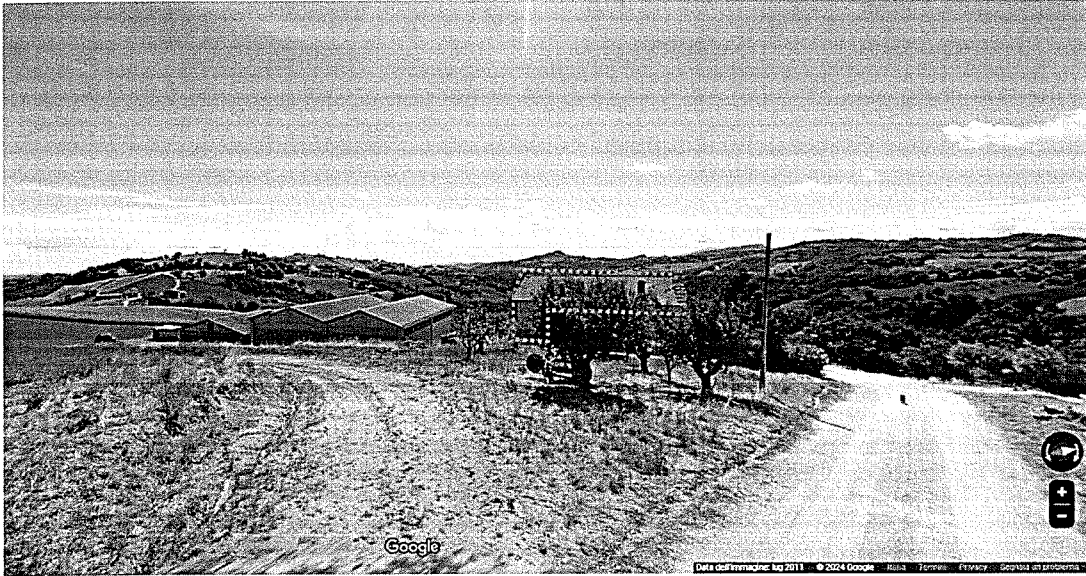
Esterno complesso edilizio con indicazione della porzione di edificio in oggetto
